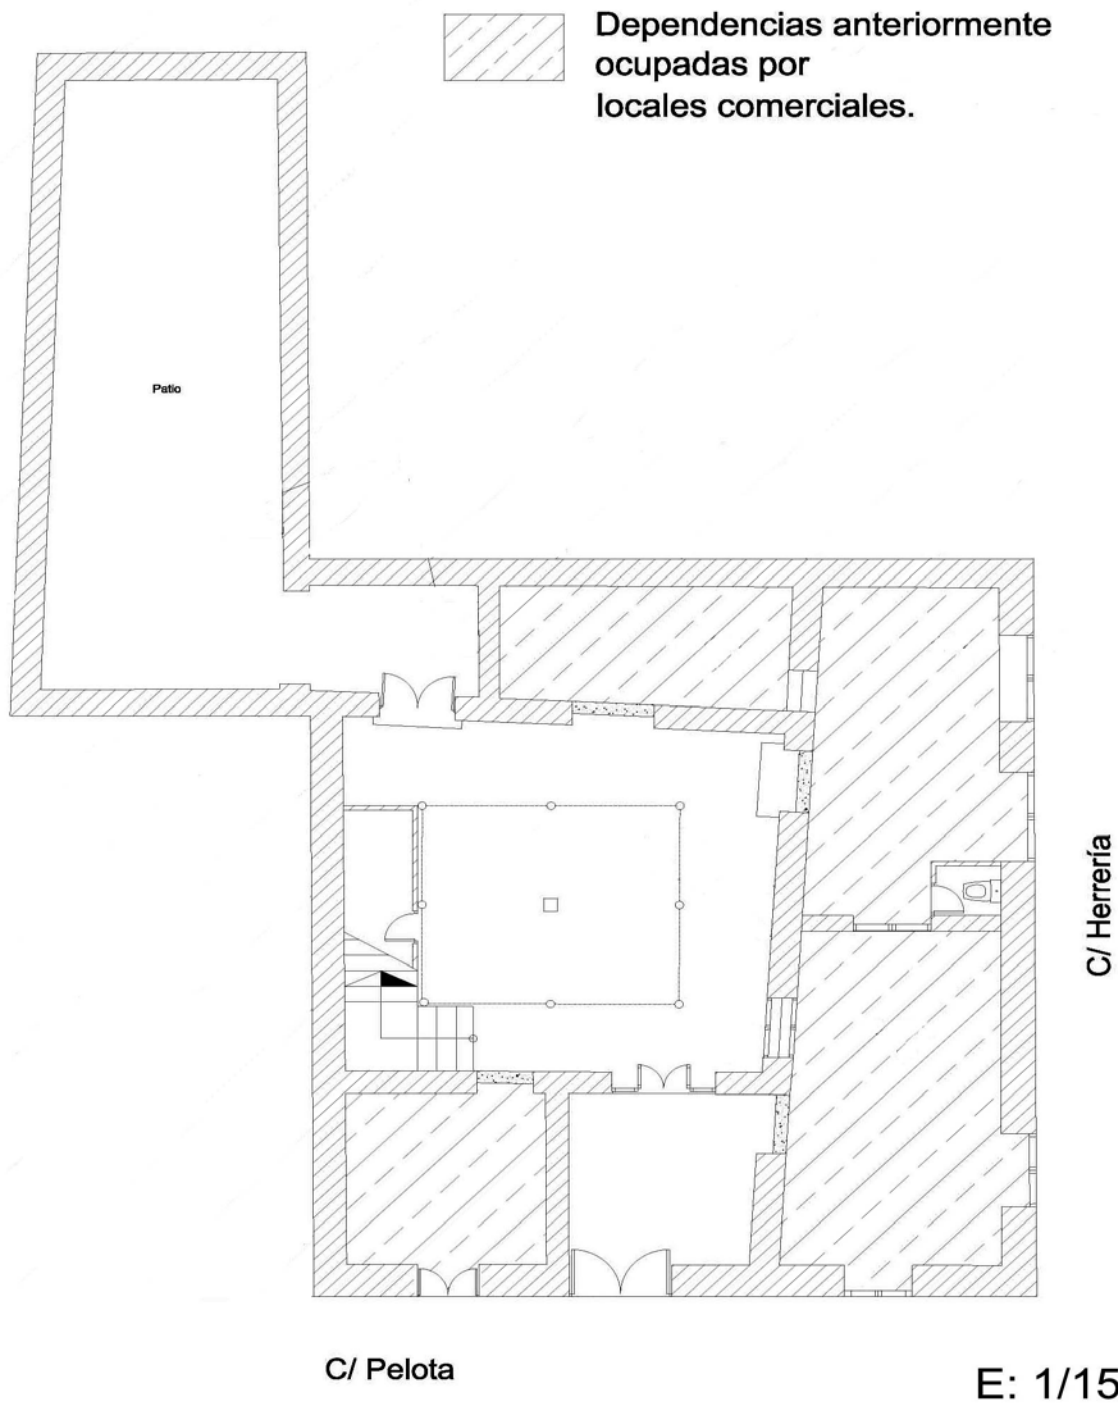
Planimetría de la Casa del Deán: Planta Baja. (Procedencia gráfica: Padrón & Trujillo Arquitectos).
